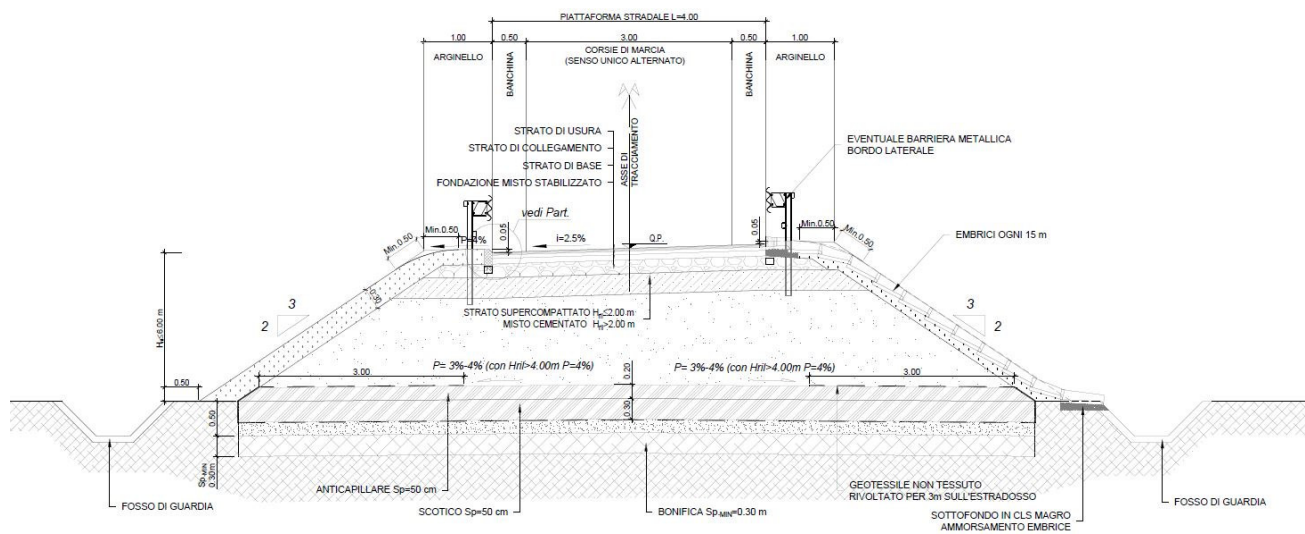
Dest. Particolare 4.0 m – sezione tipo in rilevato H_{ril} ≤ 6.00 m
